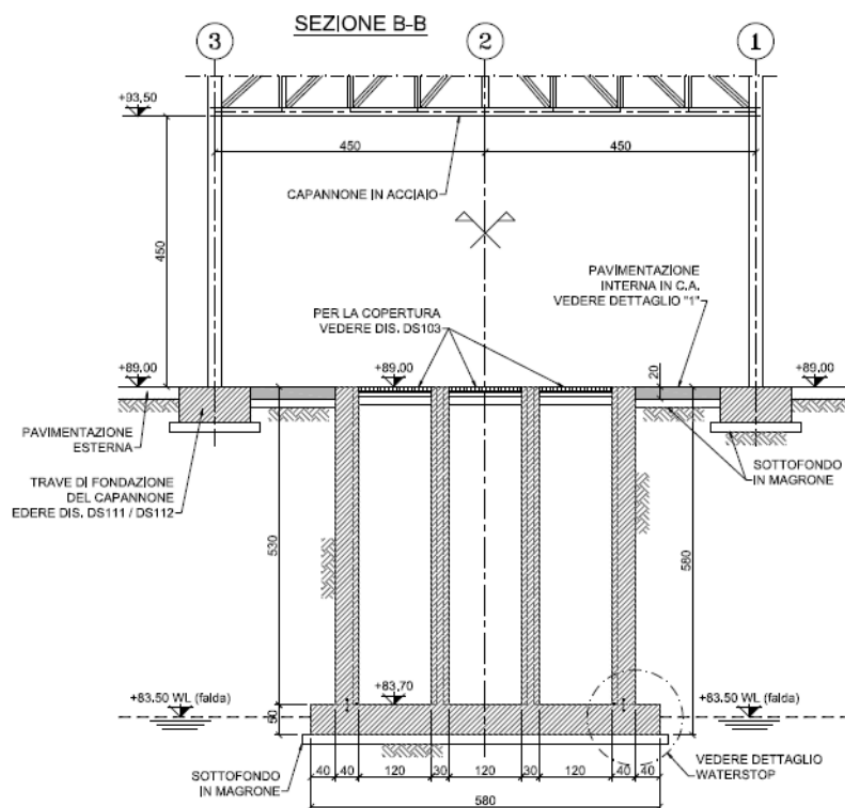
STAZIONE DI GRIGLIATURA E SOLLEVAMENTO INIZIALE – SEZIONE B-B
